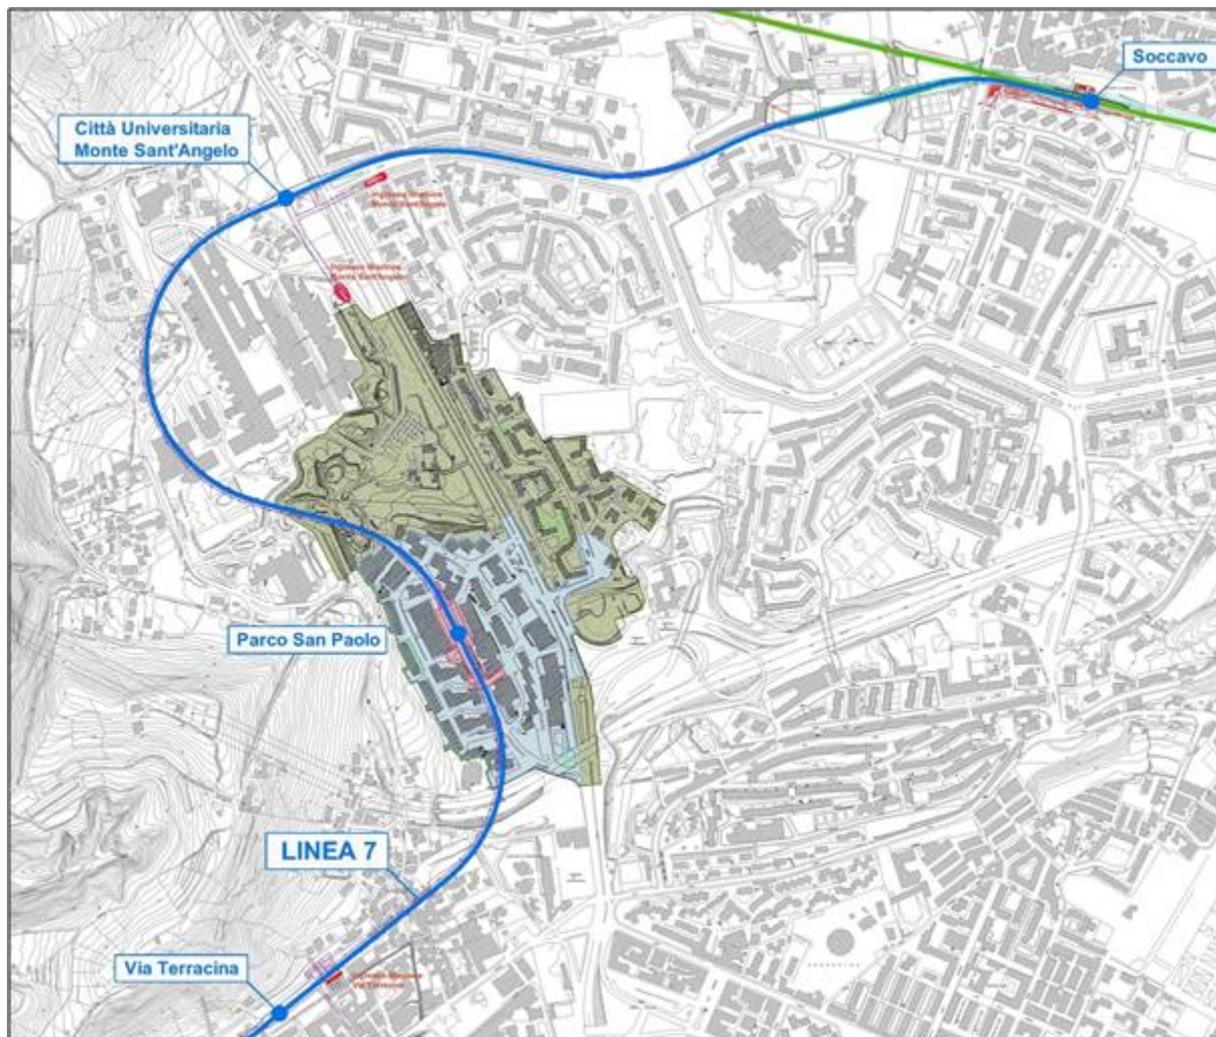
Tracciato della Bretella da Soccavo a Terracina
